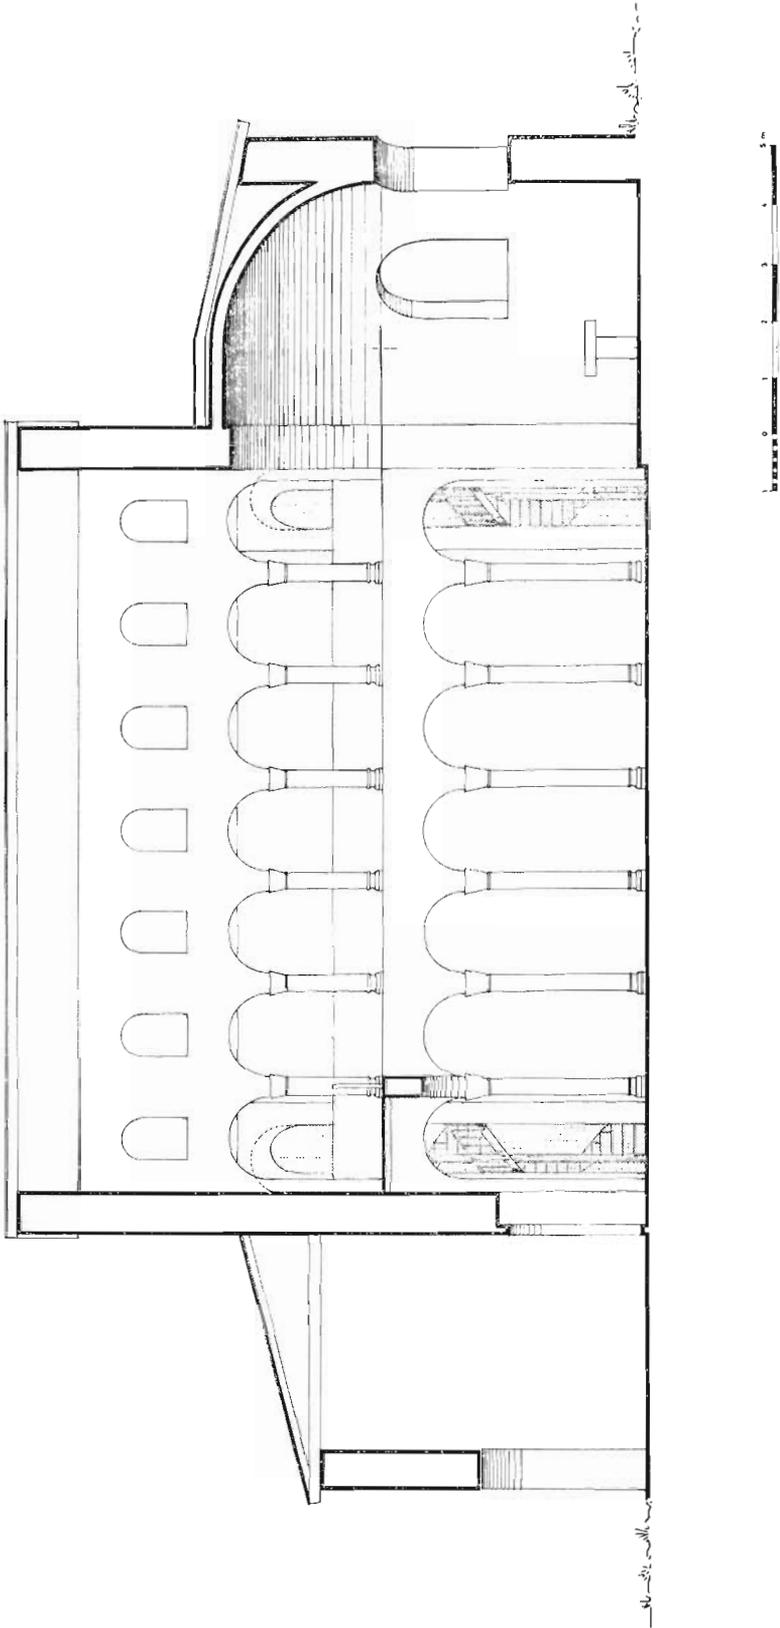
San Pedro en Veranes: sección longitudinal de la basílica (reconstrucción, según Manzanares)
